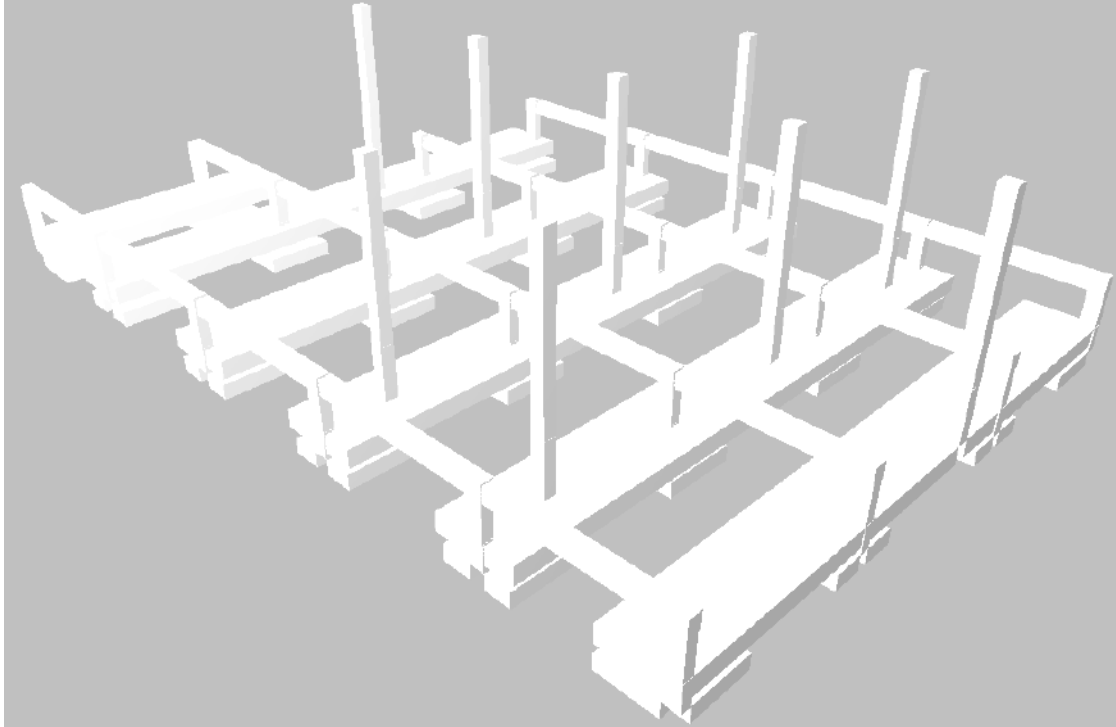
Vista 3D de Refuerzo con zapatas corrida
